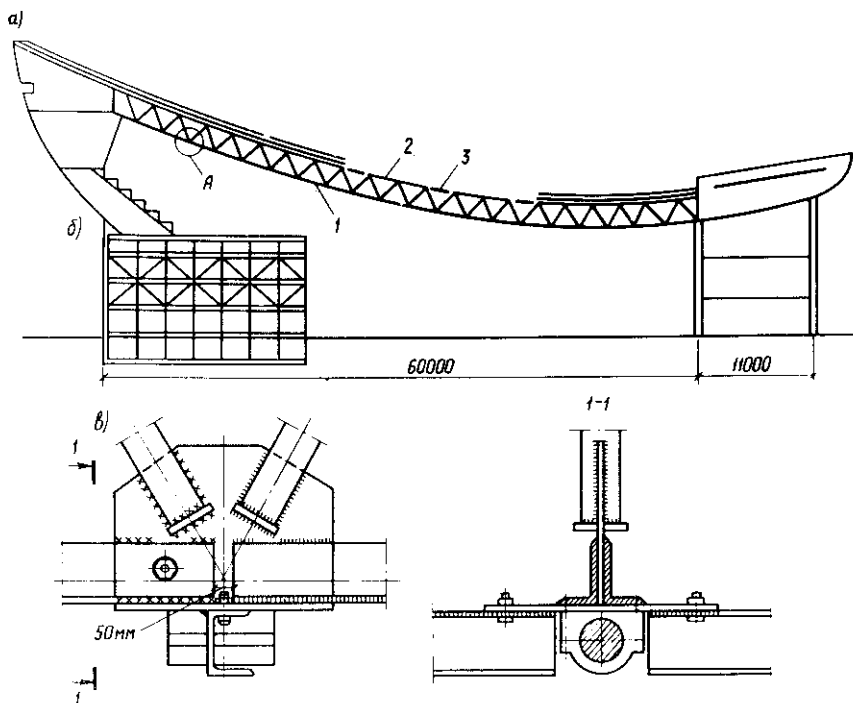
Использование жесткой фермы в покрытии Дворца имени В.И. Ленина в Вильнюсе
